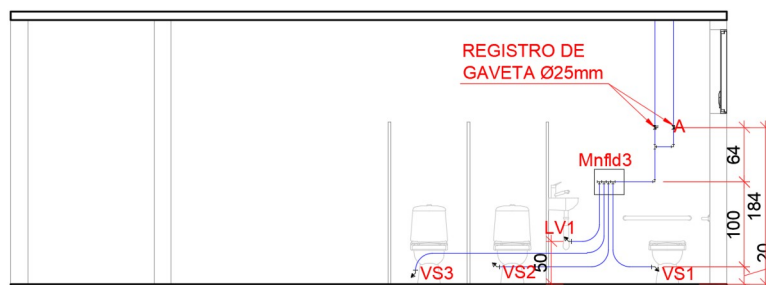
Corte A do 2º pavimento do bloco F em PEX
